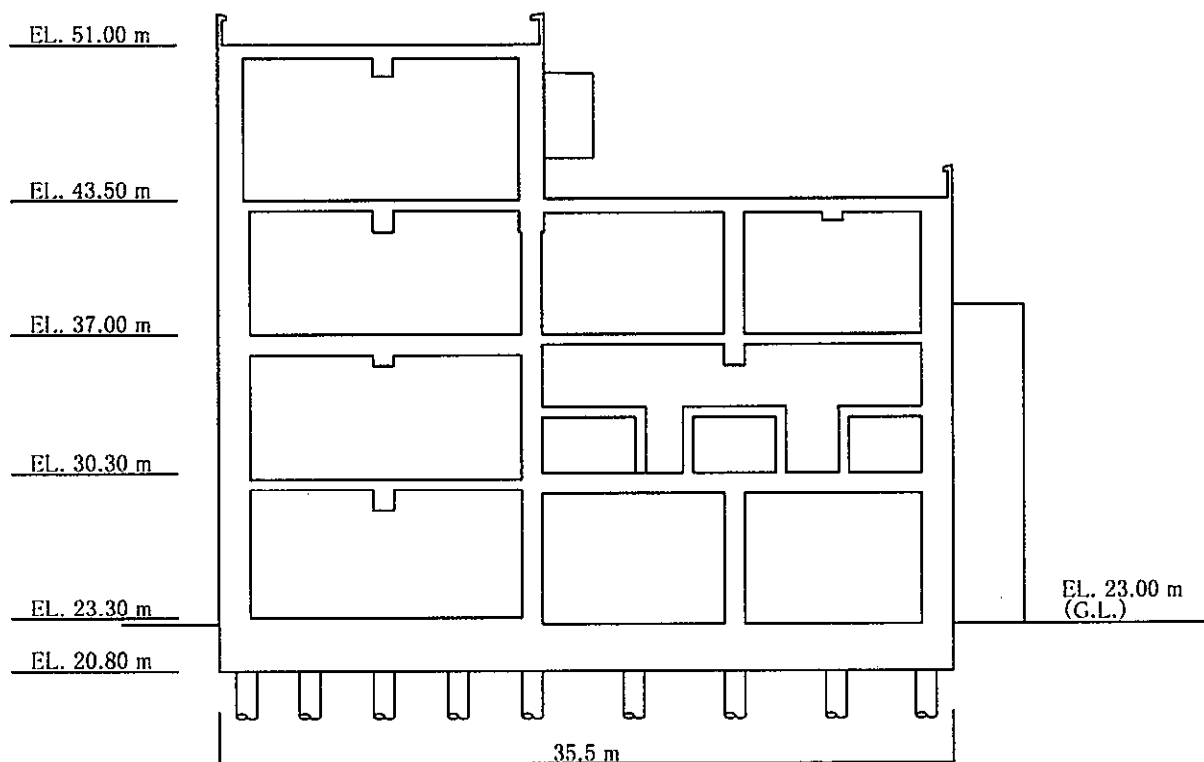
(2/2) 緊急時対策所建屋の概略断面図 (B-B 断面)
